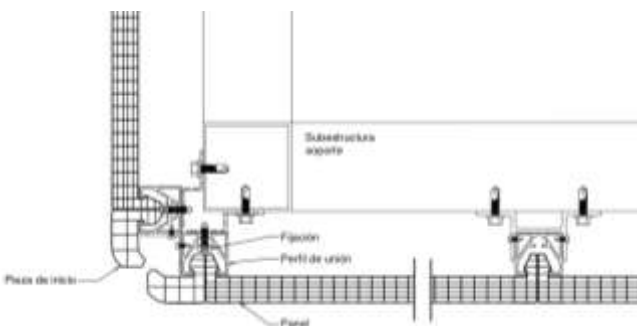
Instalación en esquina del sistema como cerramiento de fachada.
